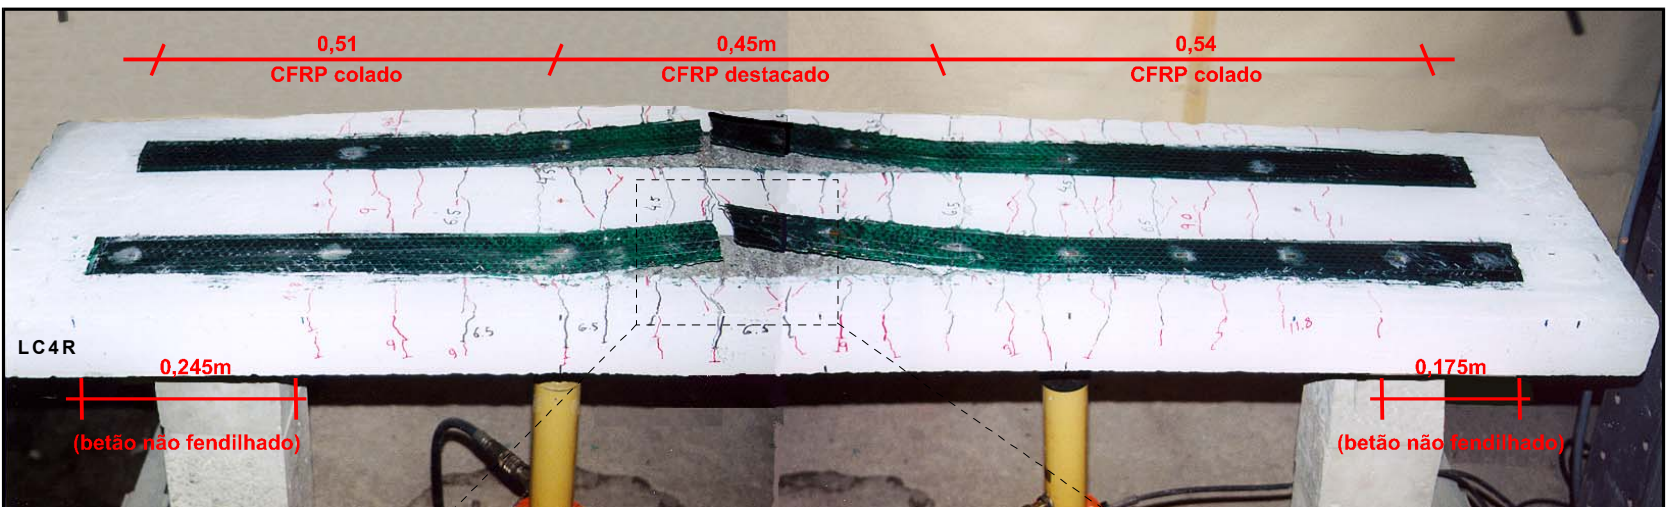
Aspecto geral da laje LC4R após o ensaio (vista e pormenor).
